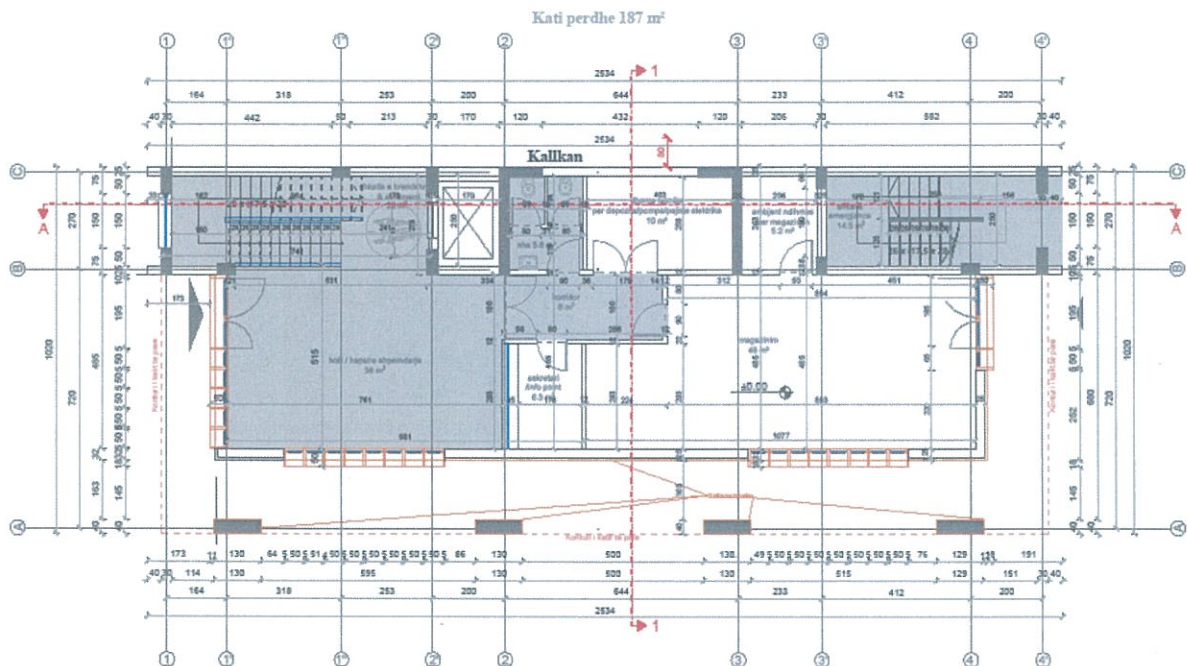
Planimetria e katit përdhe kuota ± 0.00
